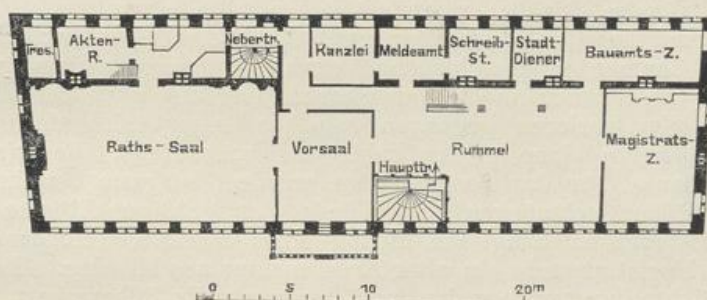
Jetziger Grundriß des Hauptgeschosses.
